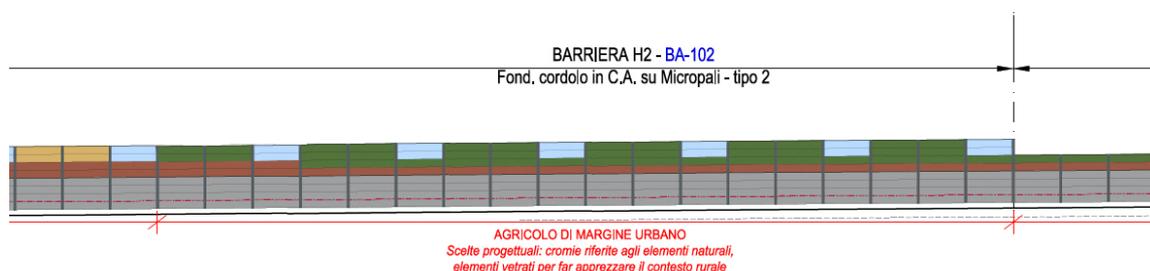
Sviluppo del prospetto della barriera BA-102 e l'inizio della BA-101 su BP
